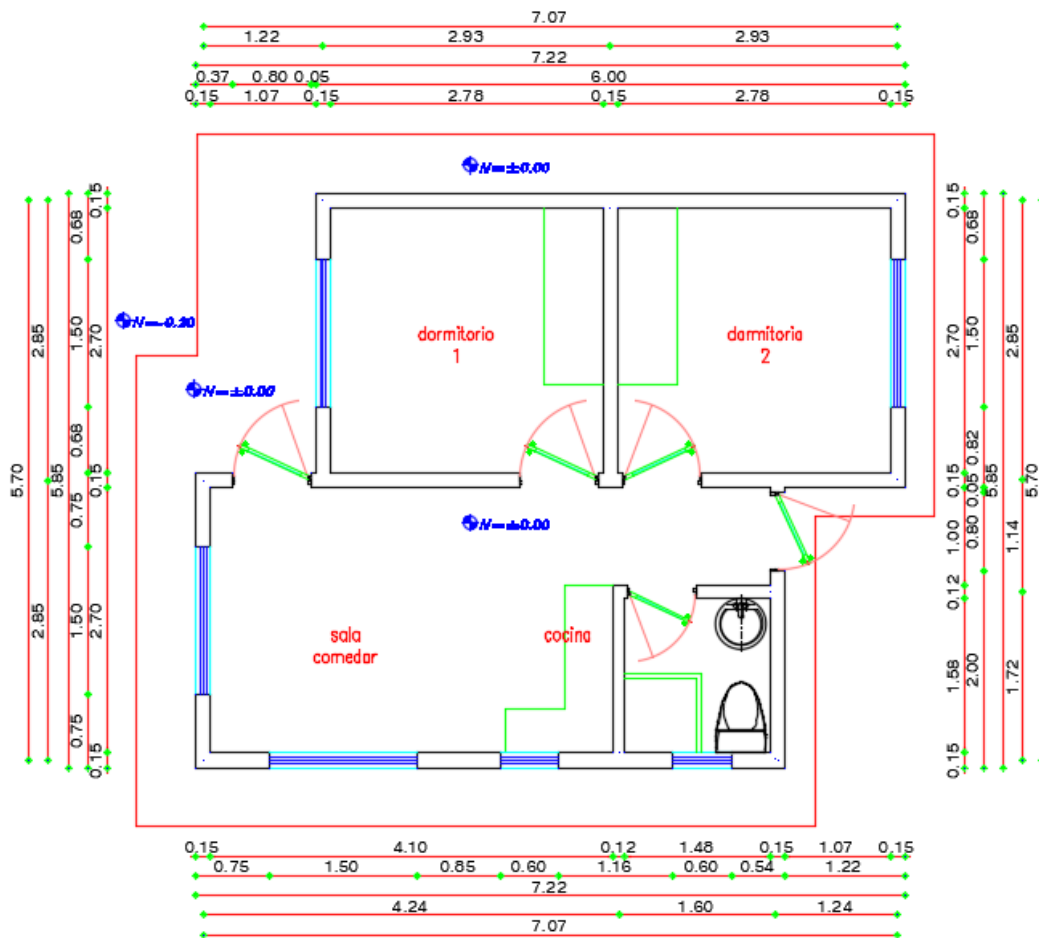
Planta Arquitectónica a Intervenir, plano prototipo
